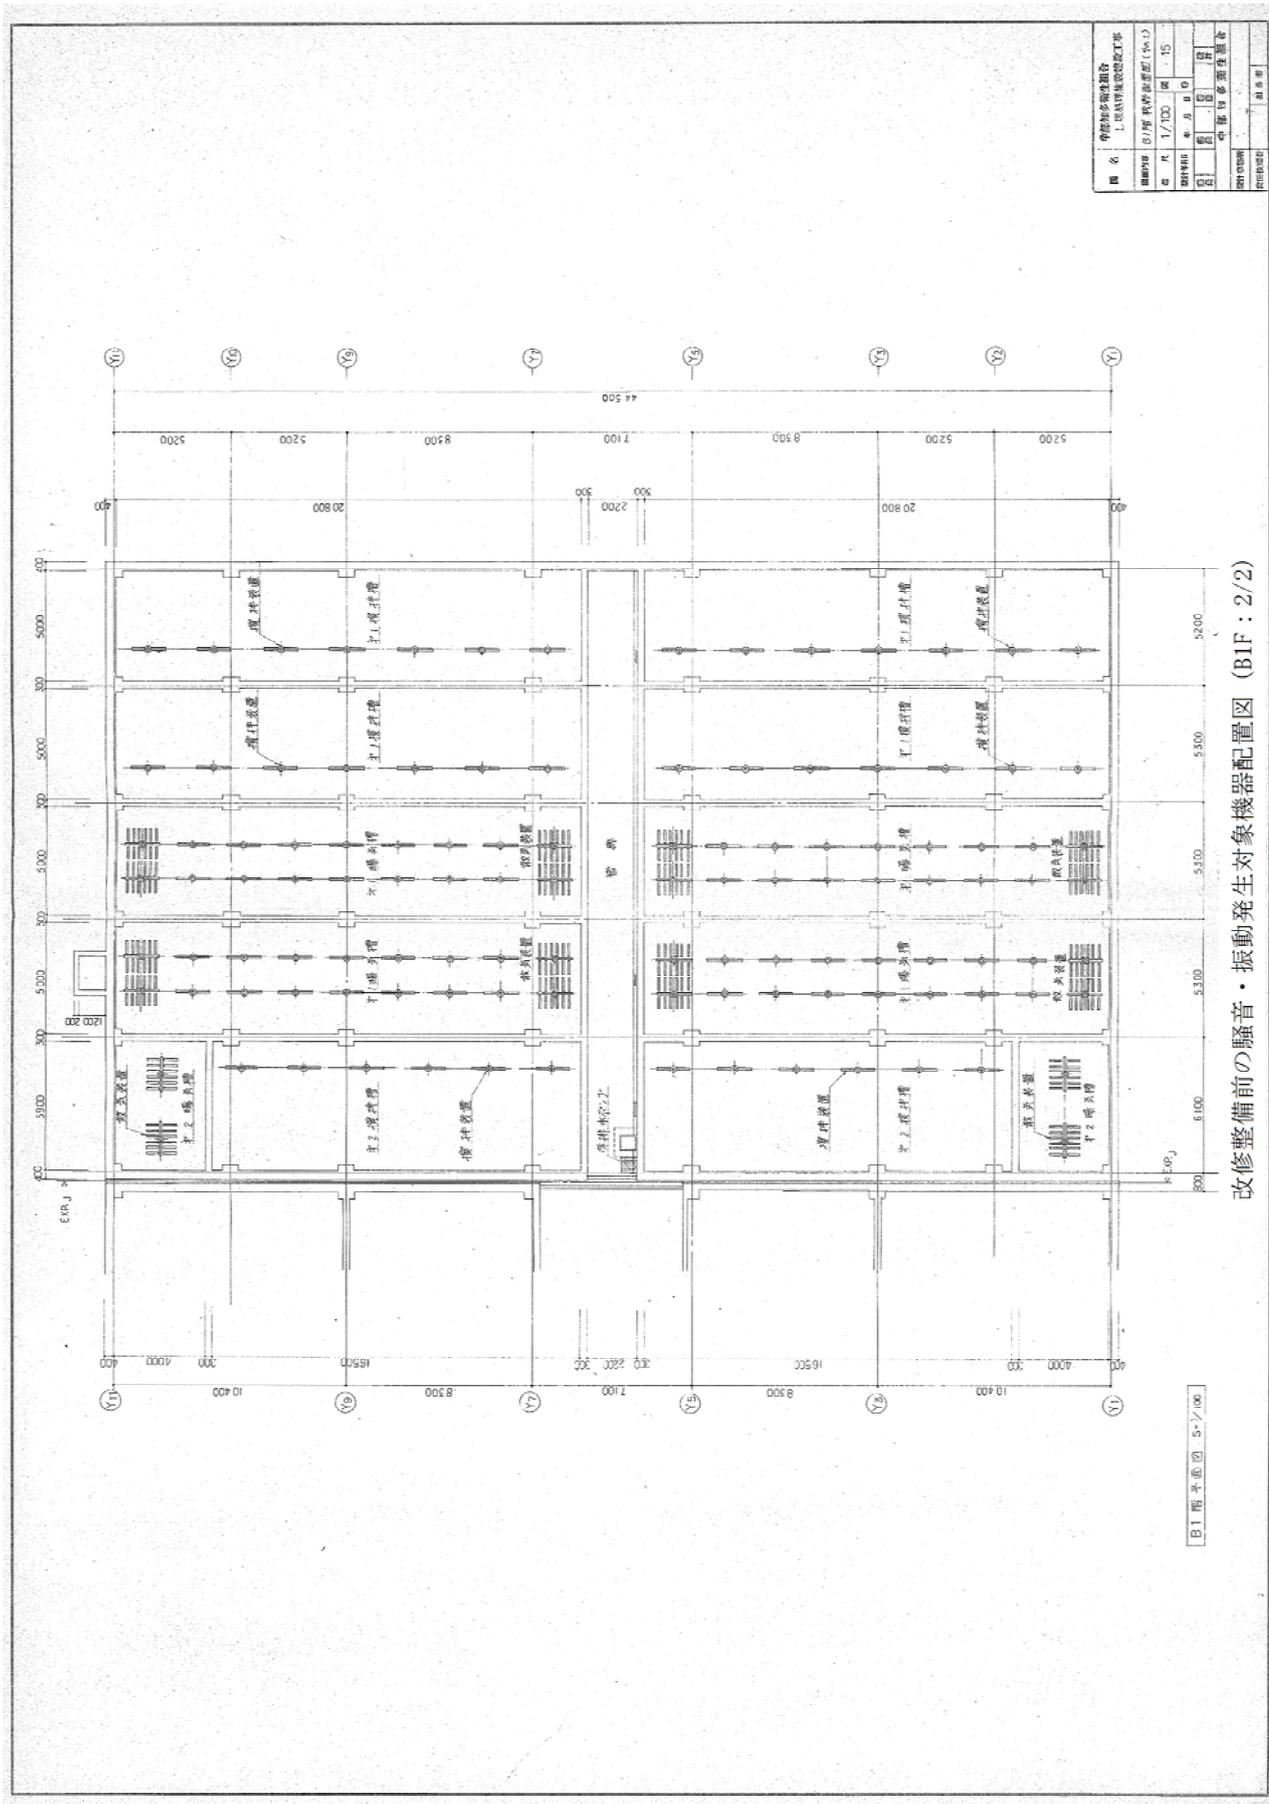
(1) 改修整備前機器配置図 (1/5)
